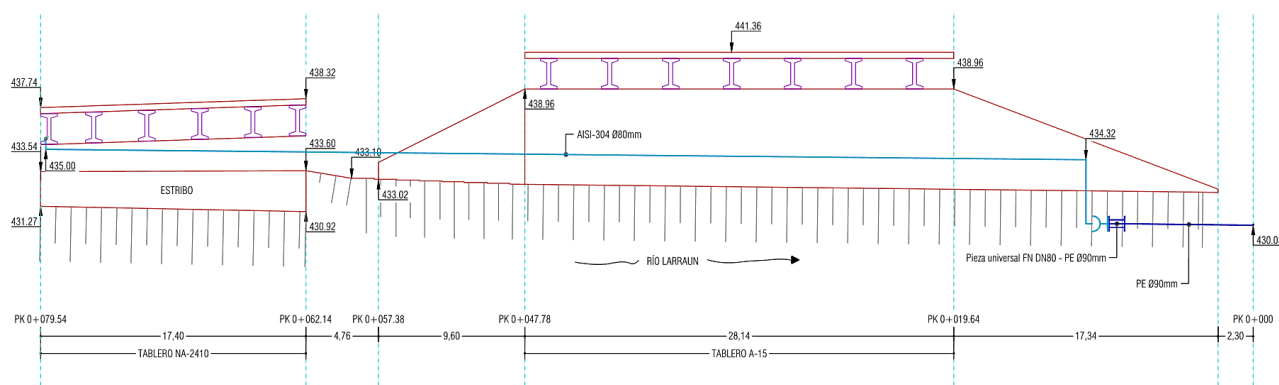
Detalle del trazado longitudinal en la zona de cruce bajo los puentes de la A-15 y del ramal de la A-15 a la NA-2410
